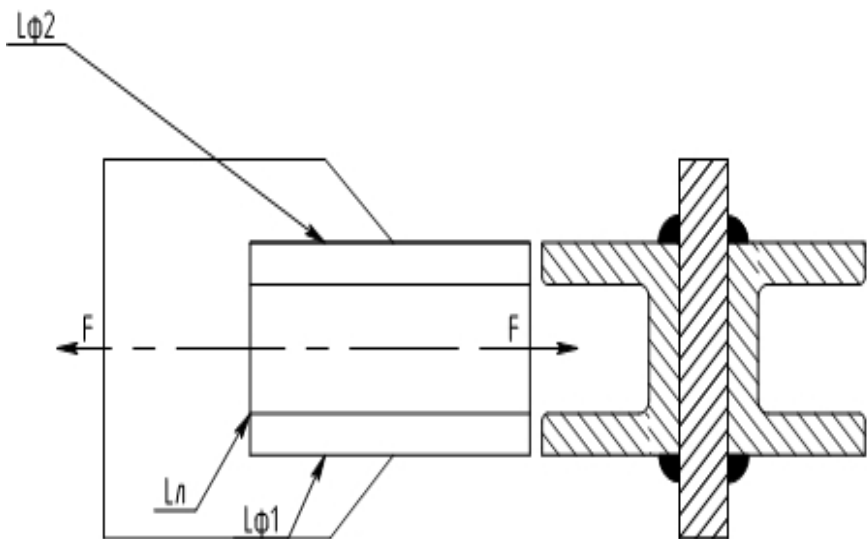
Стержень из двух швеллеров, приваренный к косынке
